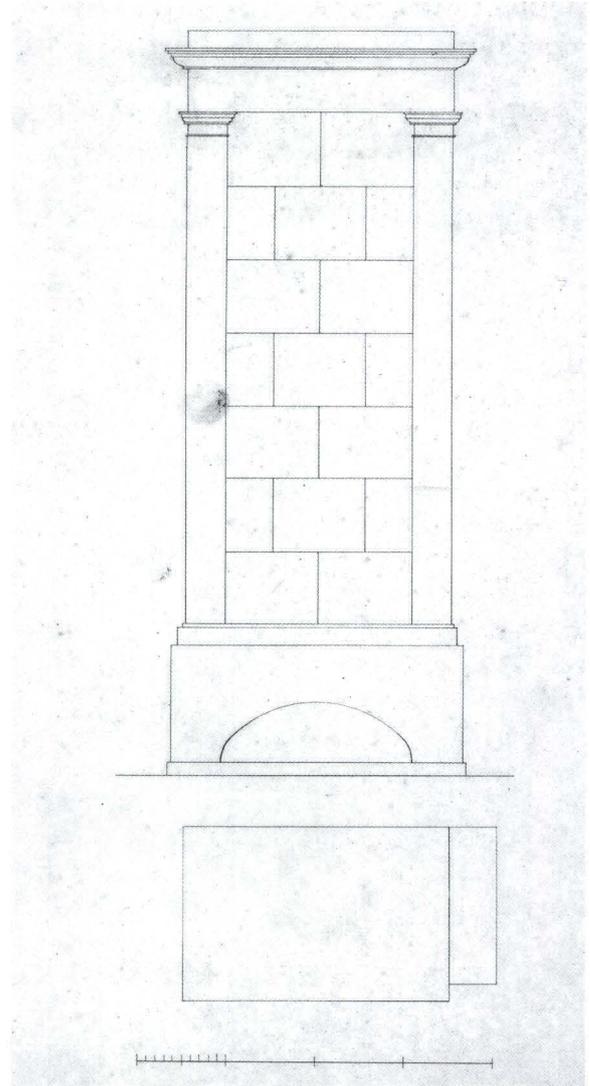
Entwurf eines Kachelofens mit Sockelfuss und Eckpfeilern auf rechteckigem Grundriss von Architekt Christoph Riggerbach (StABS: Archiv des ehemaligen Stadt- und Münster museums, Inv. A.B. 203).
